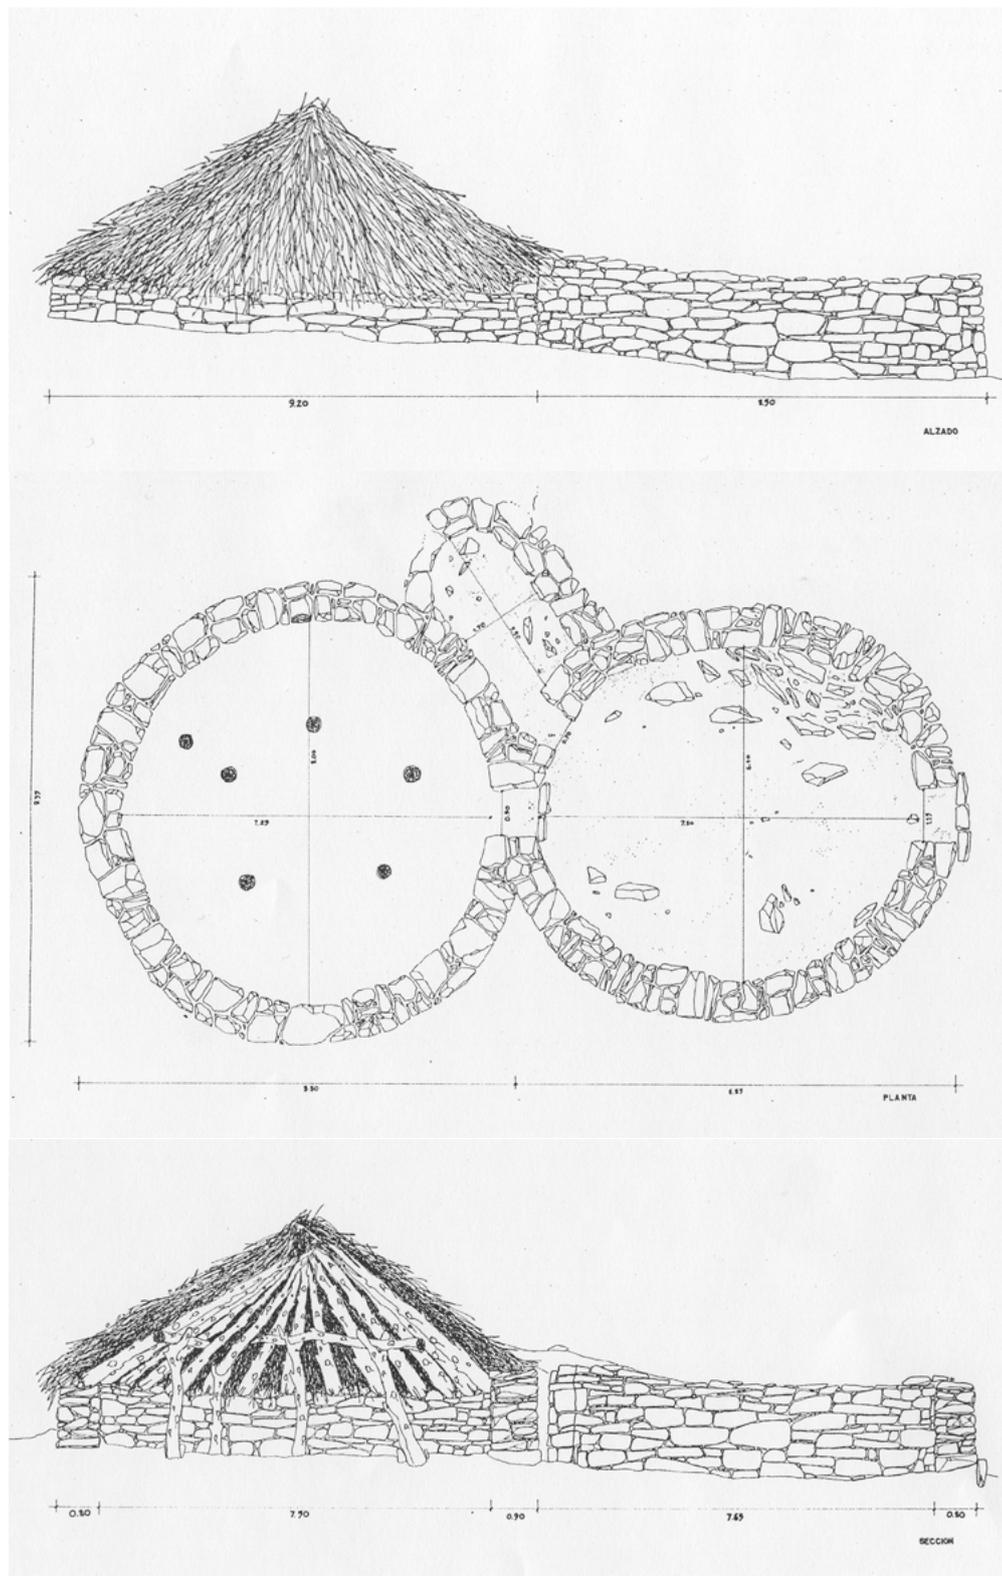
Alzado, planta y sección del chozo de Anchuelo del Campo (Guadalajara).
